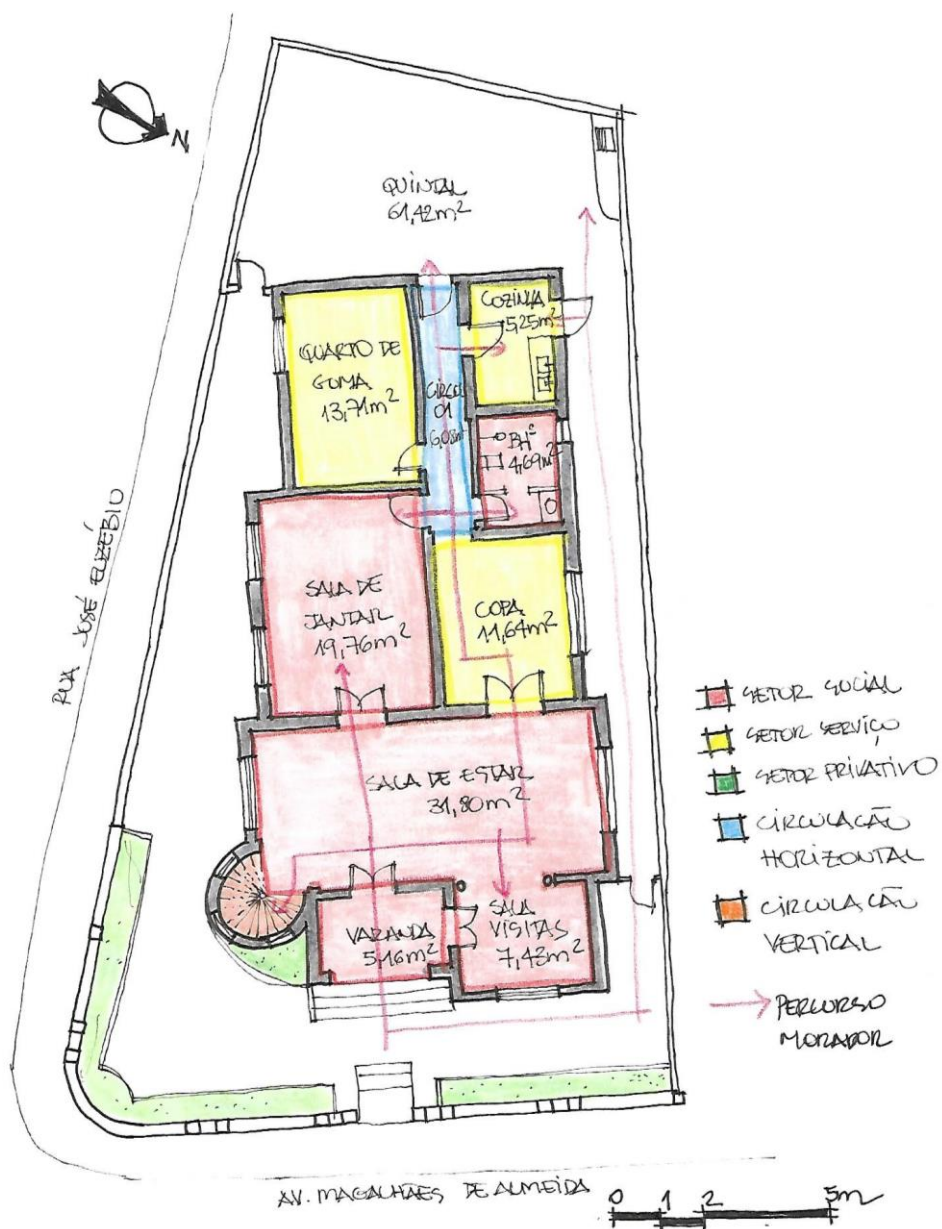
Planta do pavimento térreo da Residência nº 220. Fonte: autora, 2018.
